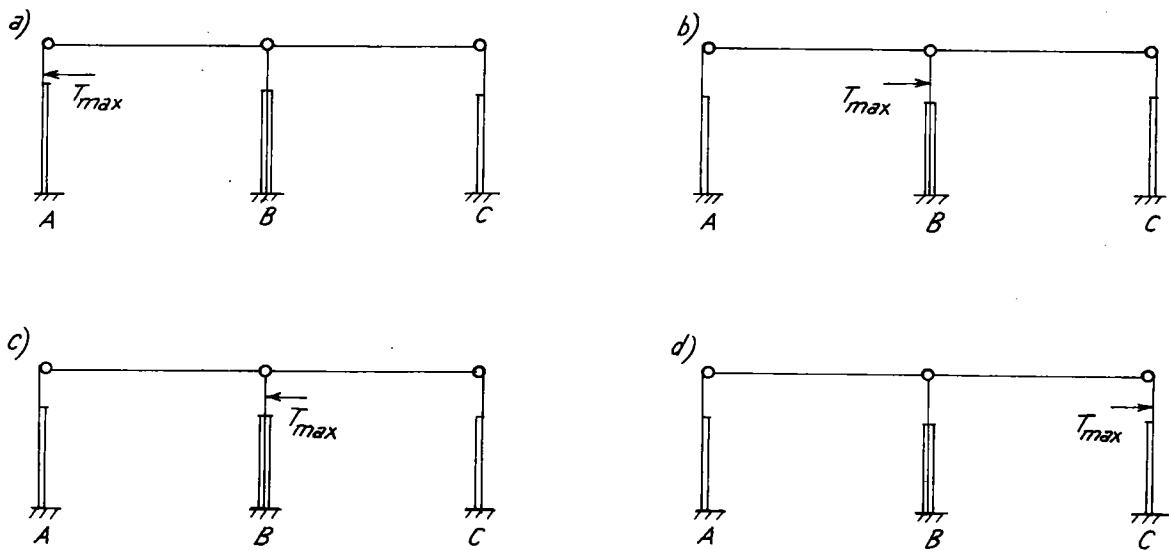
Biểu đồ mômen trong khung do các trường hợp tác dụng của hoạt tải cầu trục
